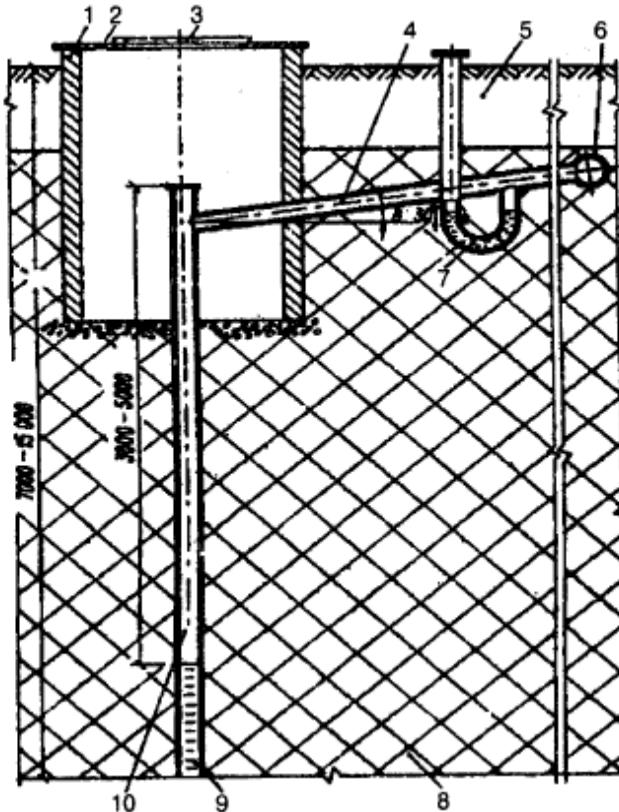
Продольный разрез рекомендуемого устройства вертикальной газосборной скважины
